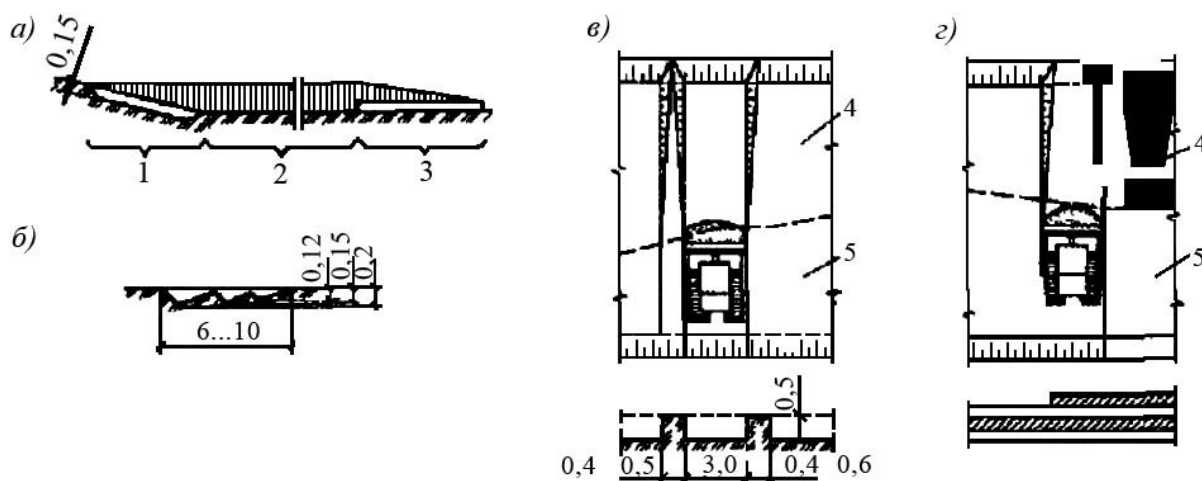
Схема резания и перемещения грунта бульдозером:
